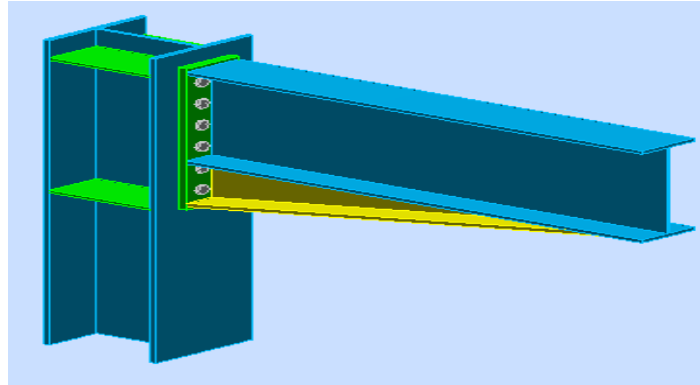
Vue de l'assemblage poteau-poutre secondaire
